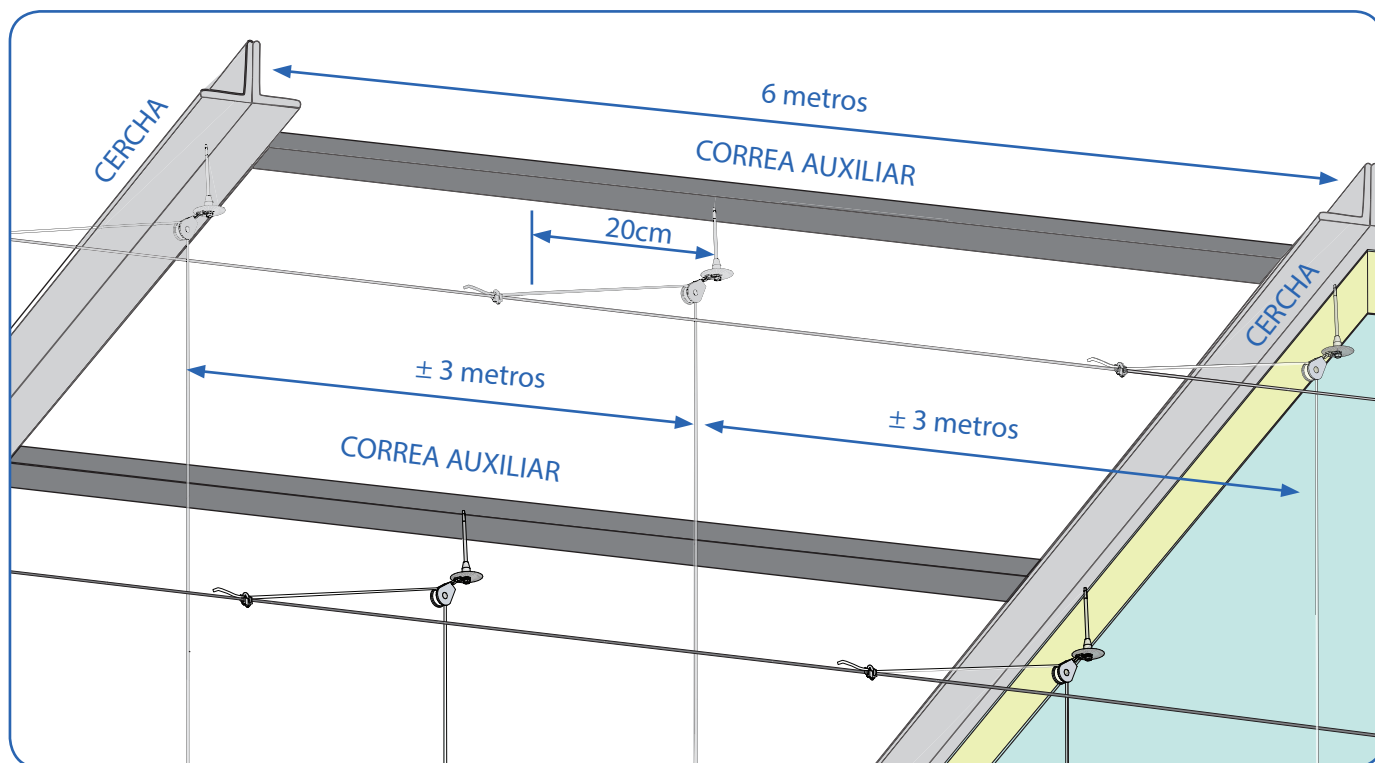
Detalle de la distancia de separación de las tulipas y del anclaje a los elementos estructurales.
